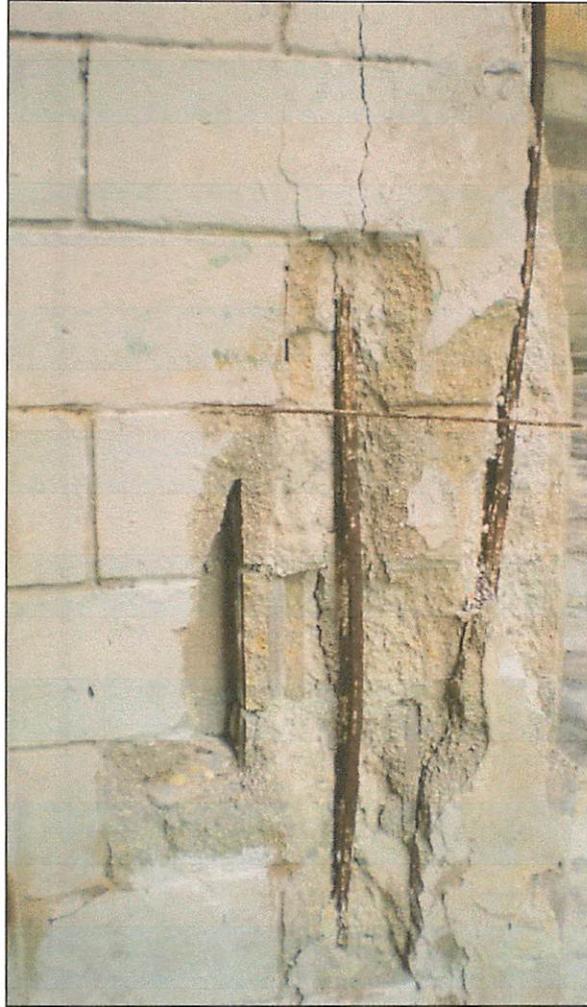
Corrosión del acero en vigas debido a la falta de recubrimiento. Fuente: Los autores, 2013.
